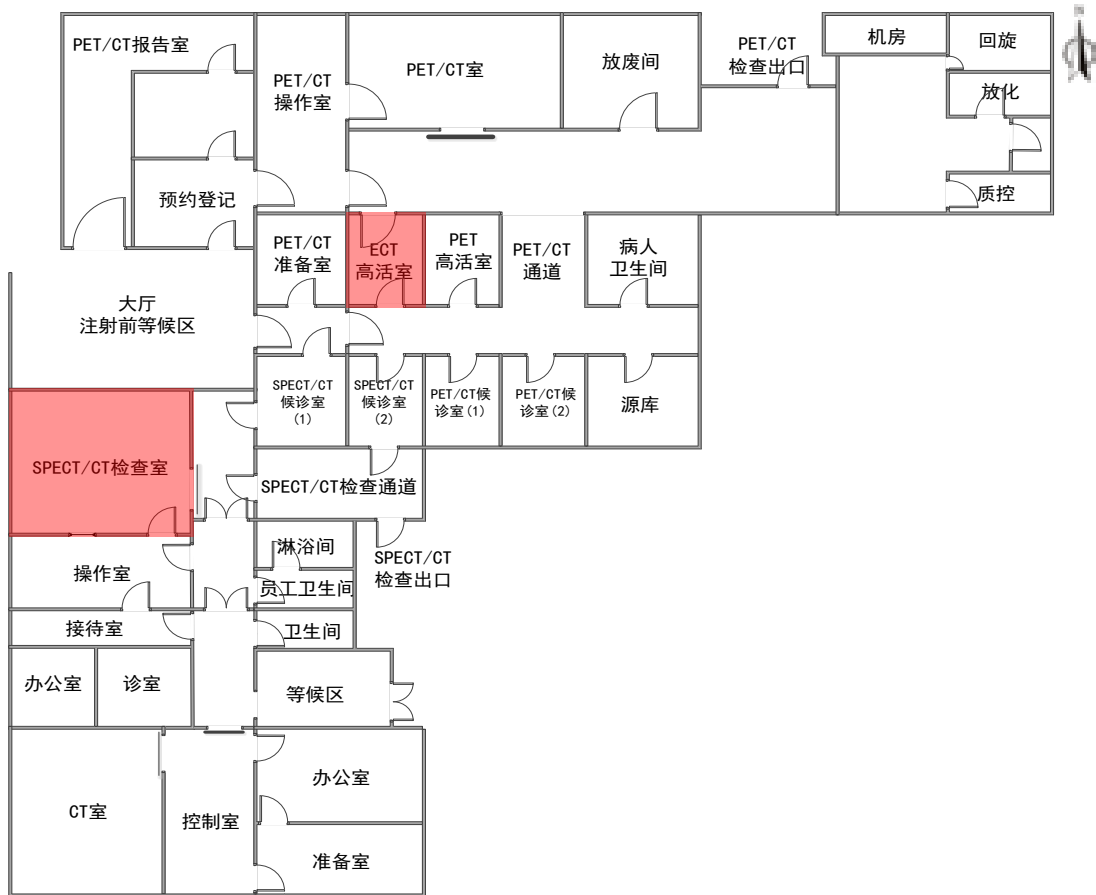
核医学楼一层平面布置示意图 (红色区域为本项目主要涉及核素的房间)
